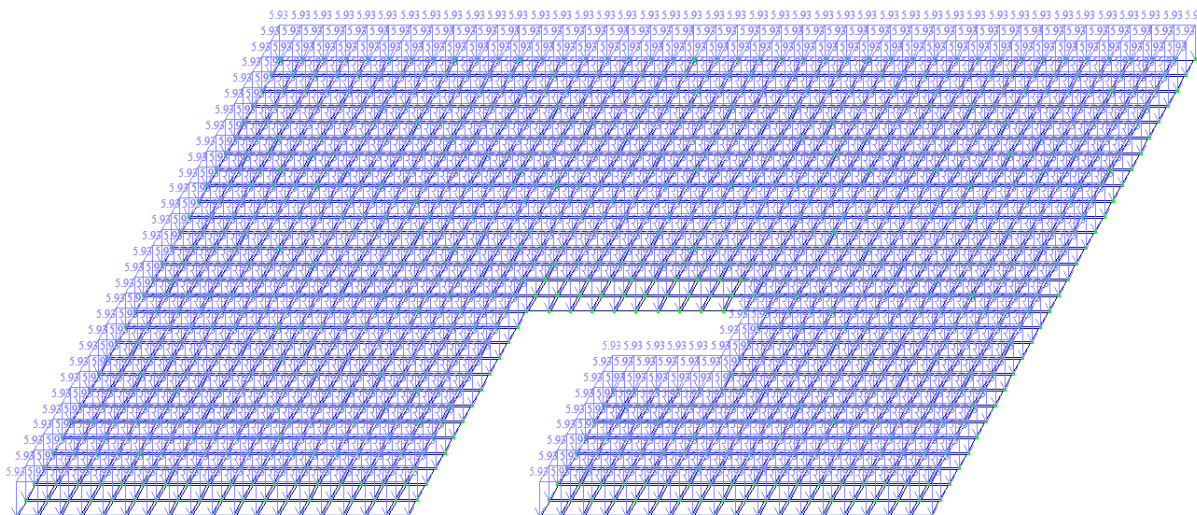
Расчетная схема участка монолитного железобетонного перекрытия в осях 1-6 с приложенной нагрузкой
